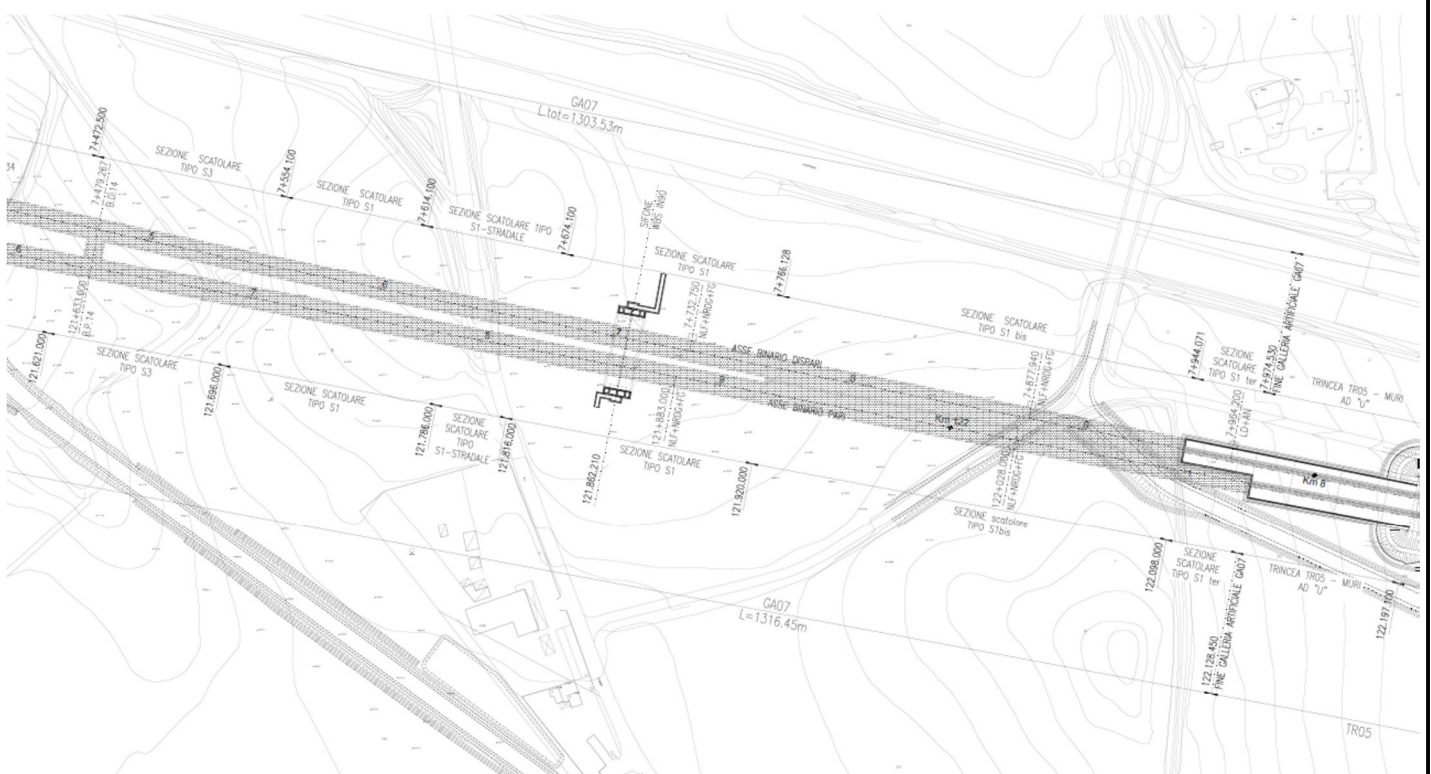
Planimetria generale della GA07 nella zona del Sifone
